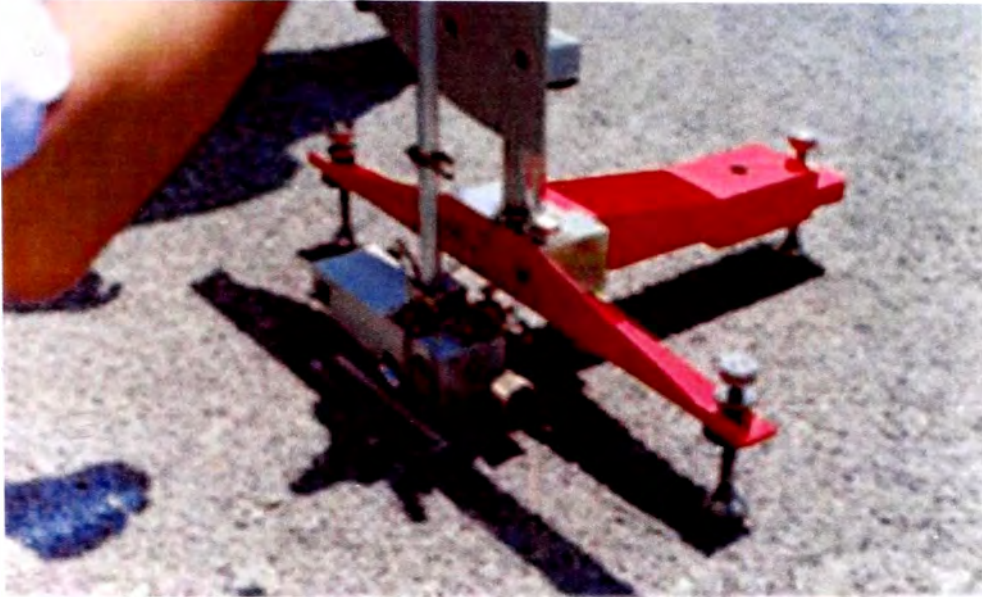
Escantillón para definir la distancia normada a deslizar la zapata del péndulo.
